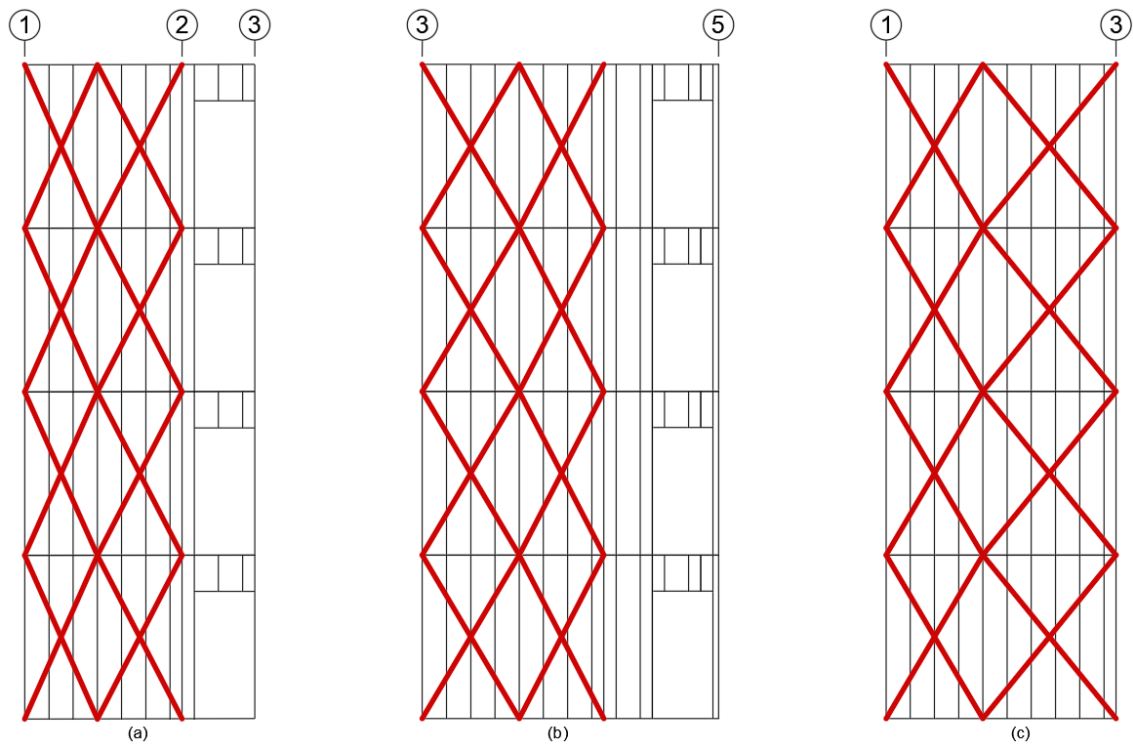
(a) Elevação F/J, (b) Elevação G/I e (c) Elevação H do Contraventamento X
